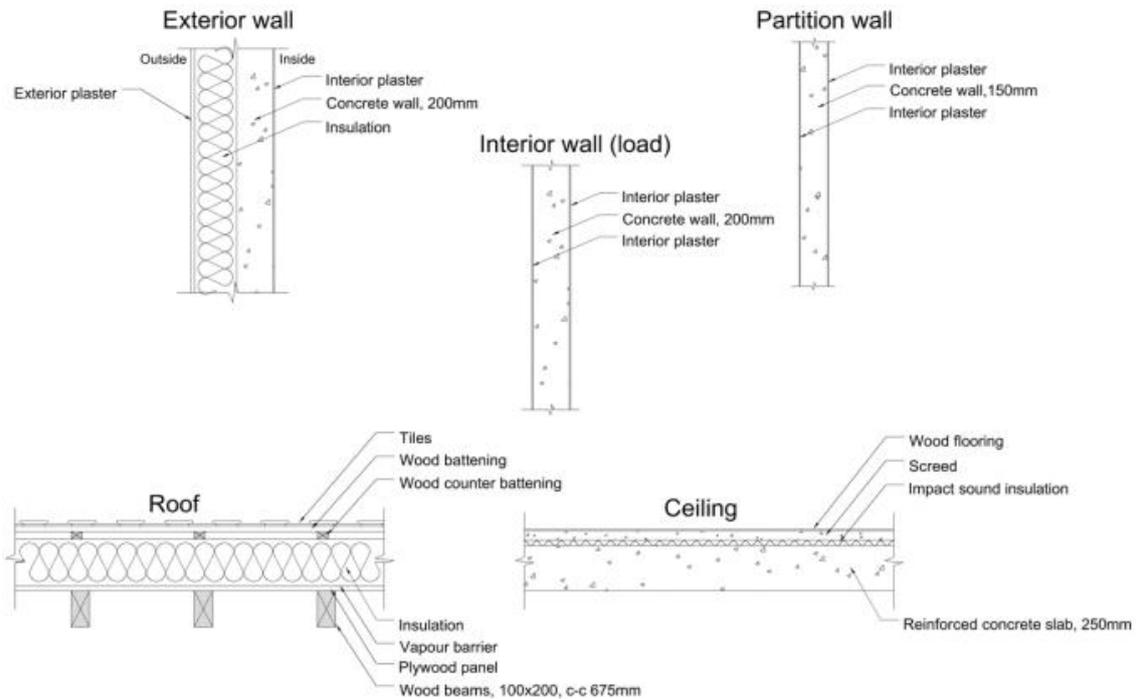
Details zu den Gebäudeelementen der Betonbauvariante (Mineralbau) des Testgebäudes.
